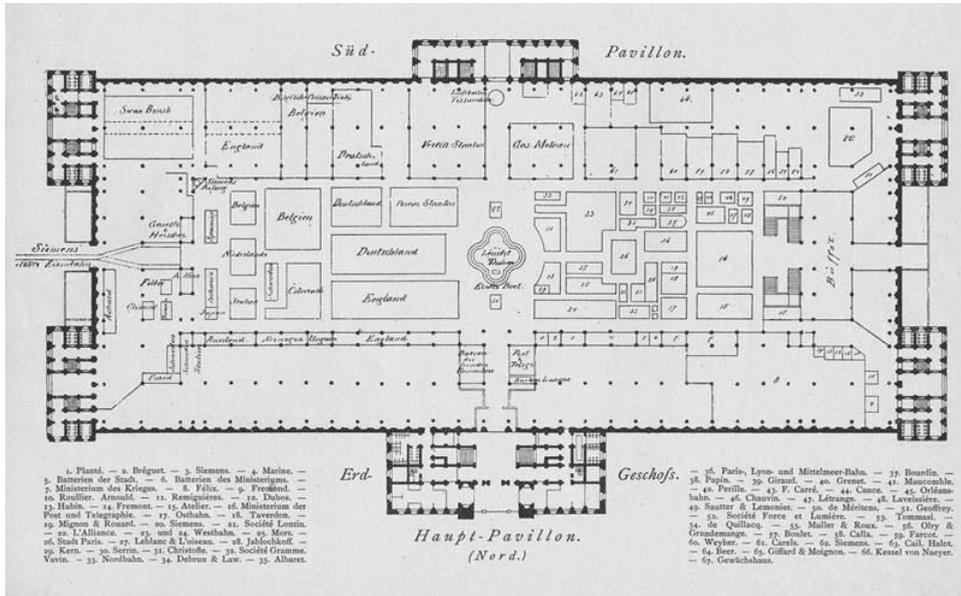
Ausstellungsplan. ETZ 2, 1881, S. 281.
